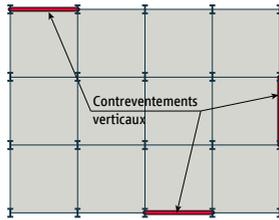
Exemple de contreventement d'un bâtiment multi-étagé
